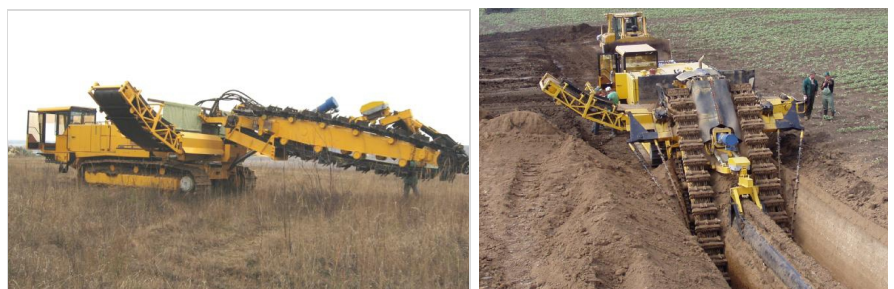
Спеціальна землерийна машина безперервної дії МВТ-2М відкриття трубопроводів
